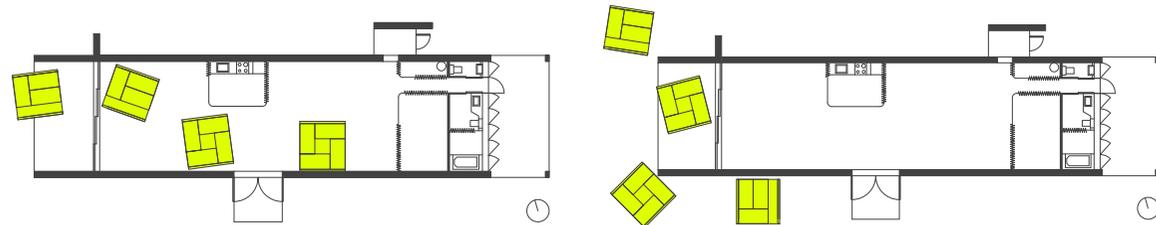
Grundrisse „Naked House“ mit ausschwärmenden Raumboxen, eigene Darstellung
